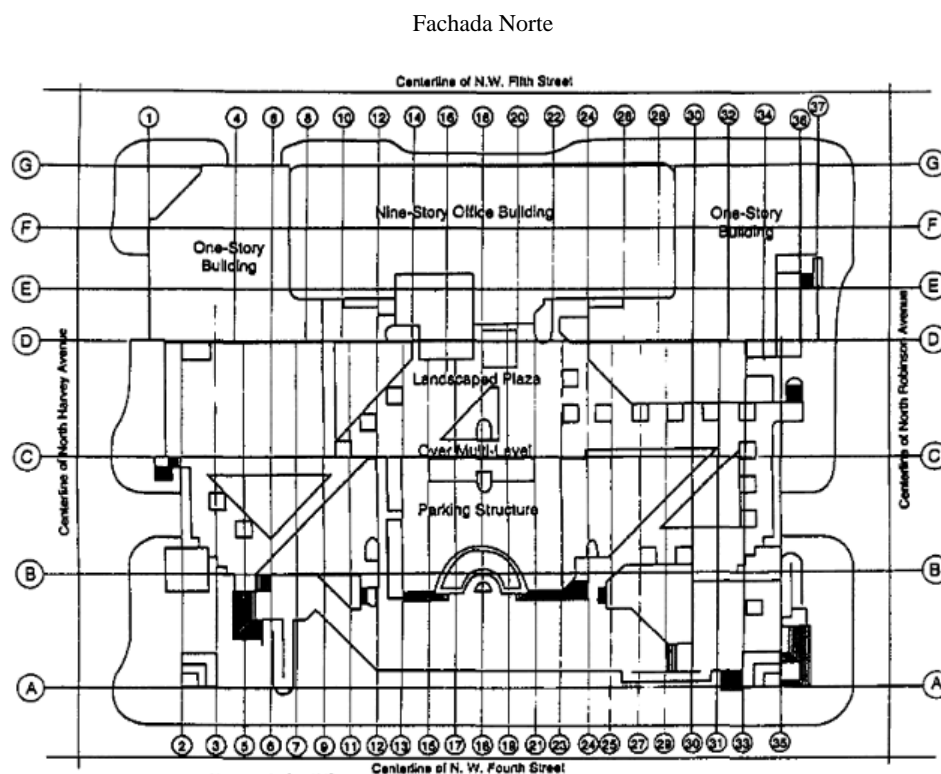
Planta do edifício Murrah – Fonte: (Corley et al., 1998)
